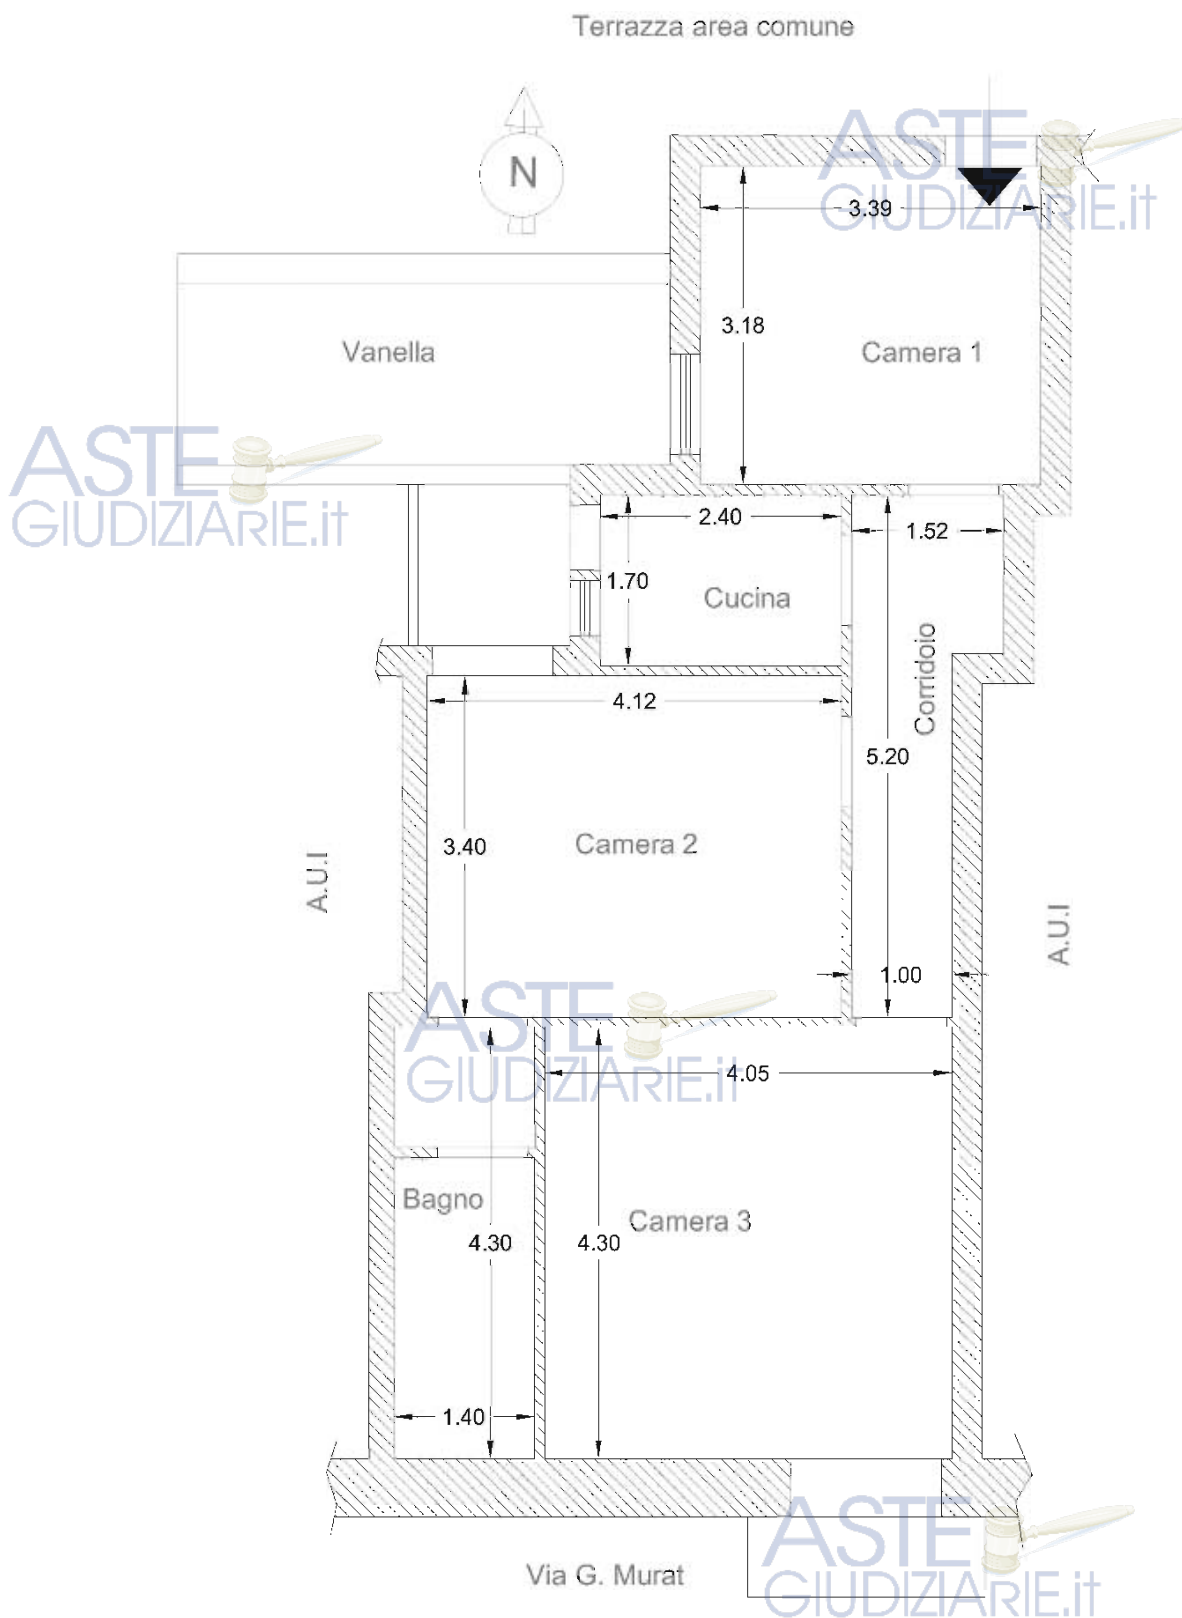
Planimetria Sub n. 27–Stato di Fatto
